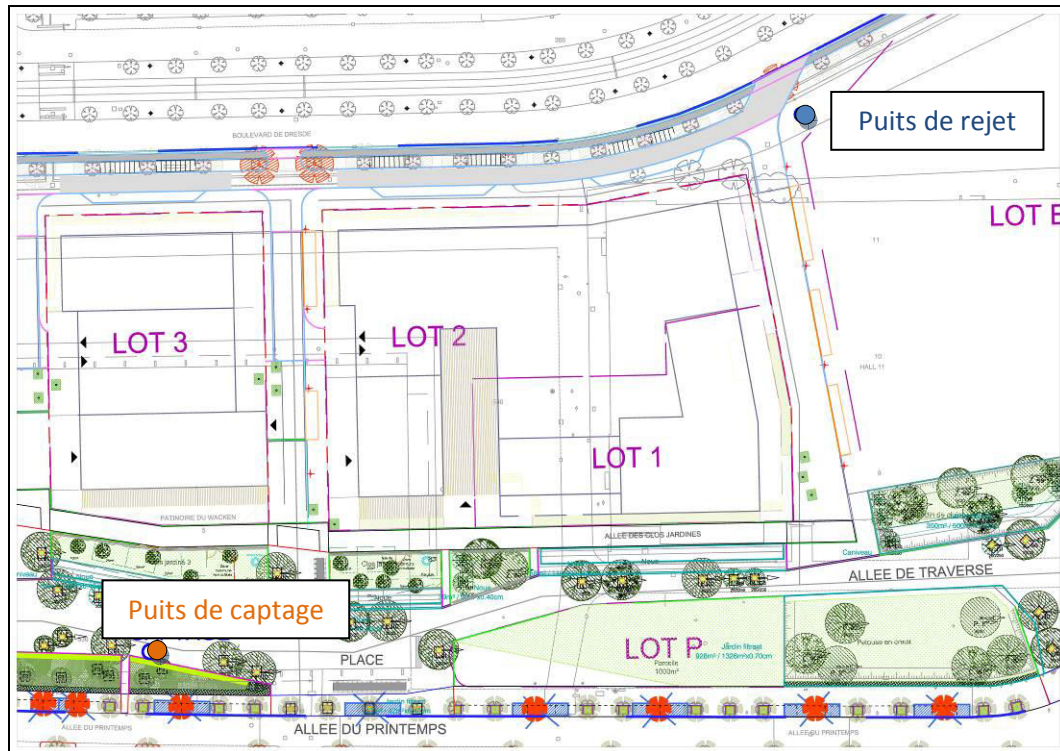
Implantations prévisionnelles des puits sur plan masse
